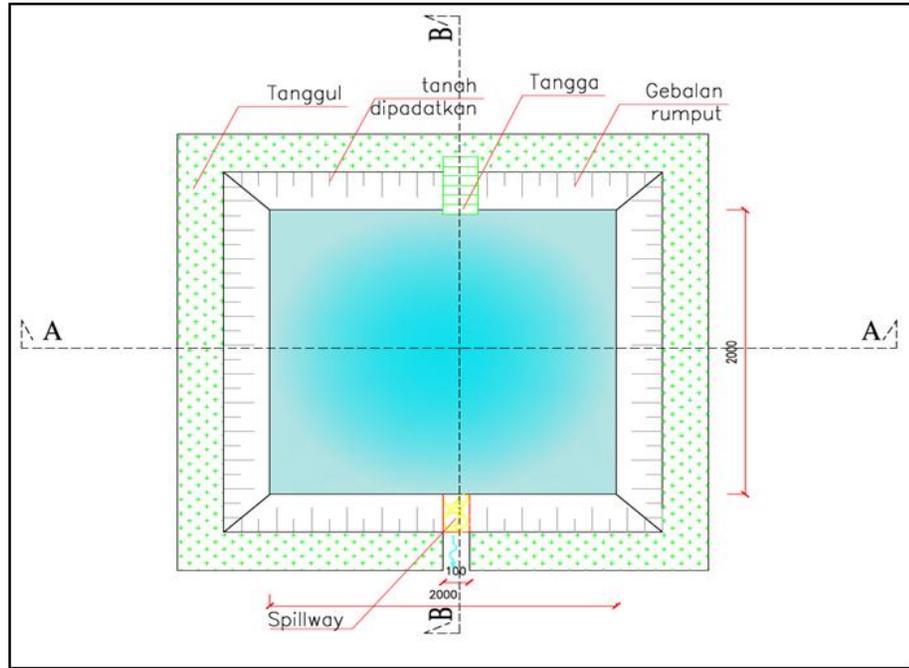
Detail tanggul keliling, tangga dan inlet air dari embung air dengan bahan spesi batu
